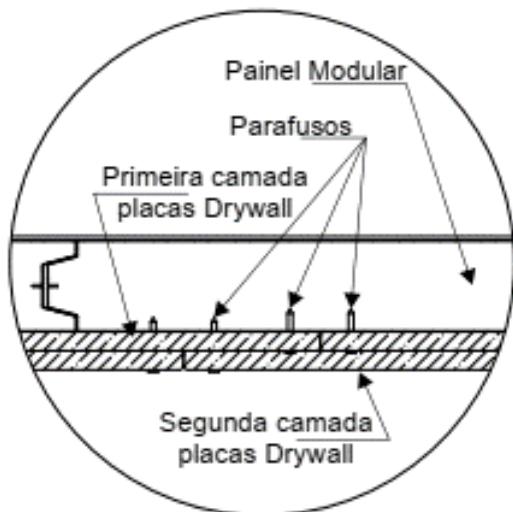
Detalhe da fixação do revestimento duplo de Drywall
